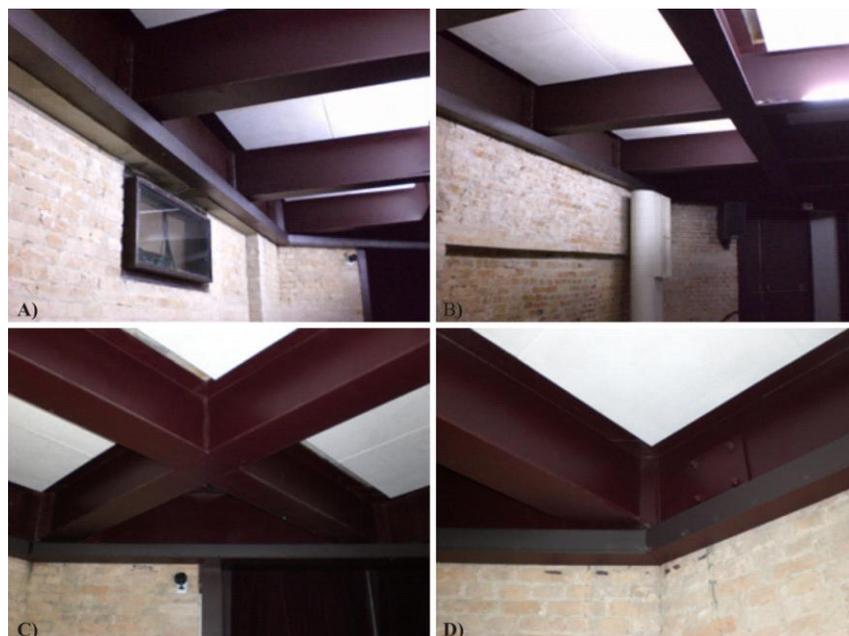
Detalhes de interfaces entre o anel da grelha metálica e a alvenaria estrutural existente.
